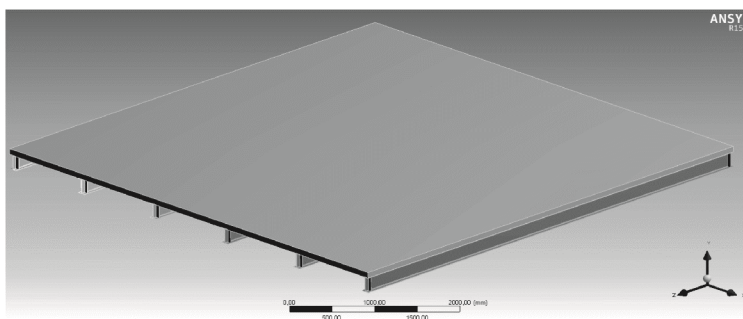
Модель сталежелезобетонной плиты с ребрами из гнутых профилей
